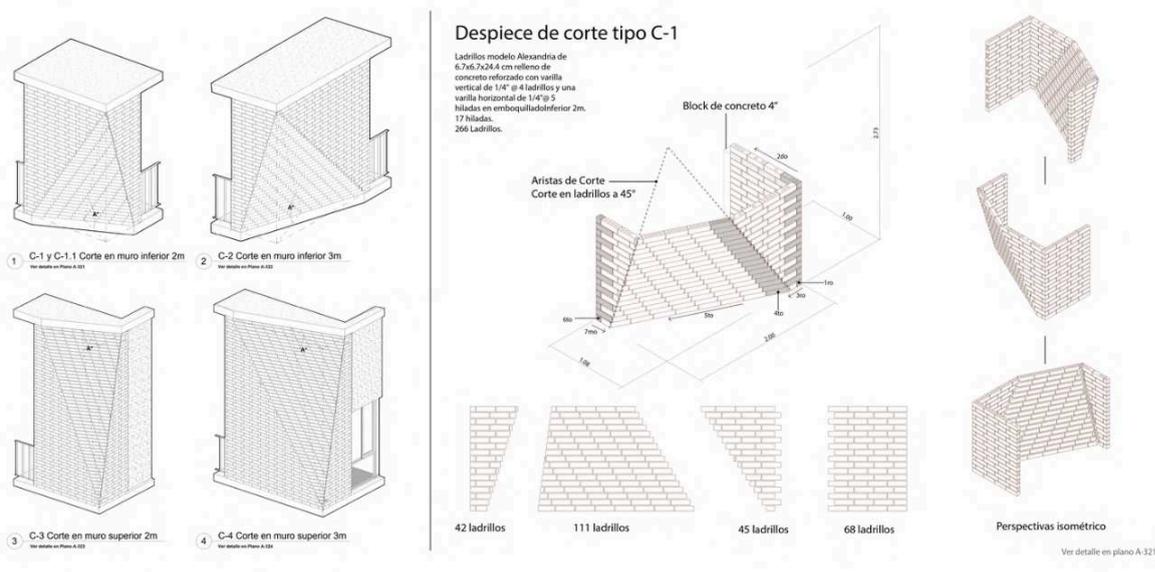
Detalhes construtivos: as subtrações da fachada. Fonte: Archdaily
